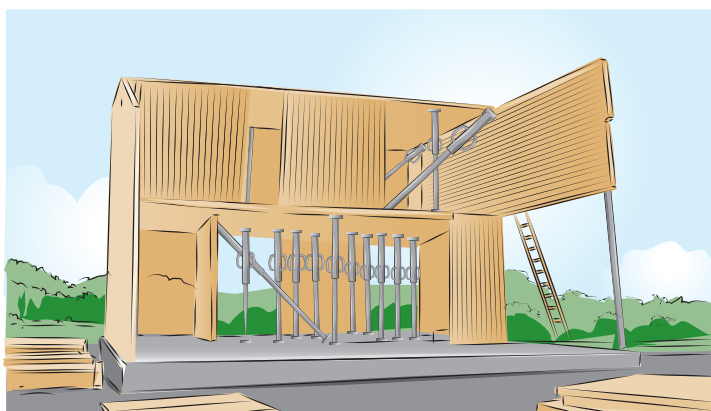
Panneaux en CLT utilisés en murs appuyés et en murs poutres
